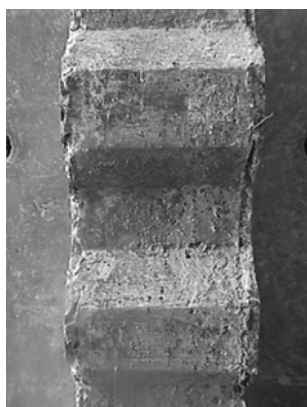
Aspecto de las llaves de los paneles laterales con hormigón con fibras
